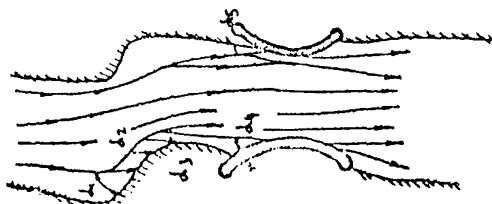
Схема к определению угла набег на откосы регуляционных сооружений.
